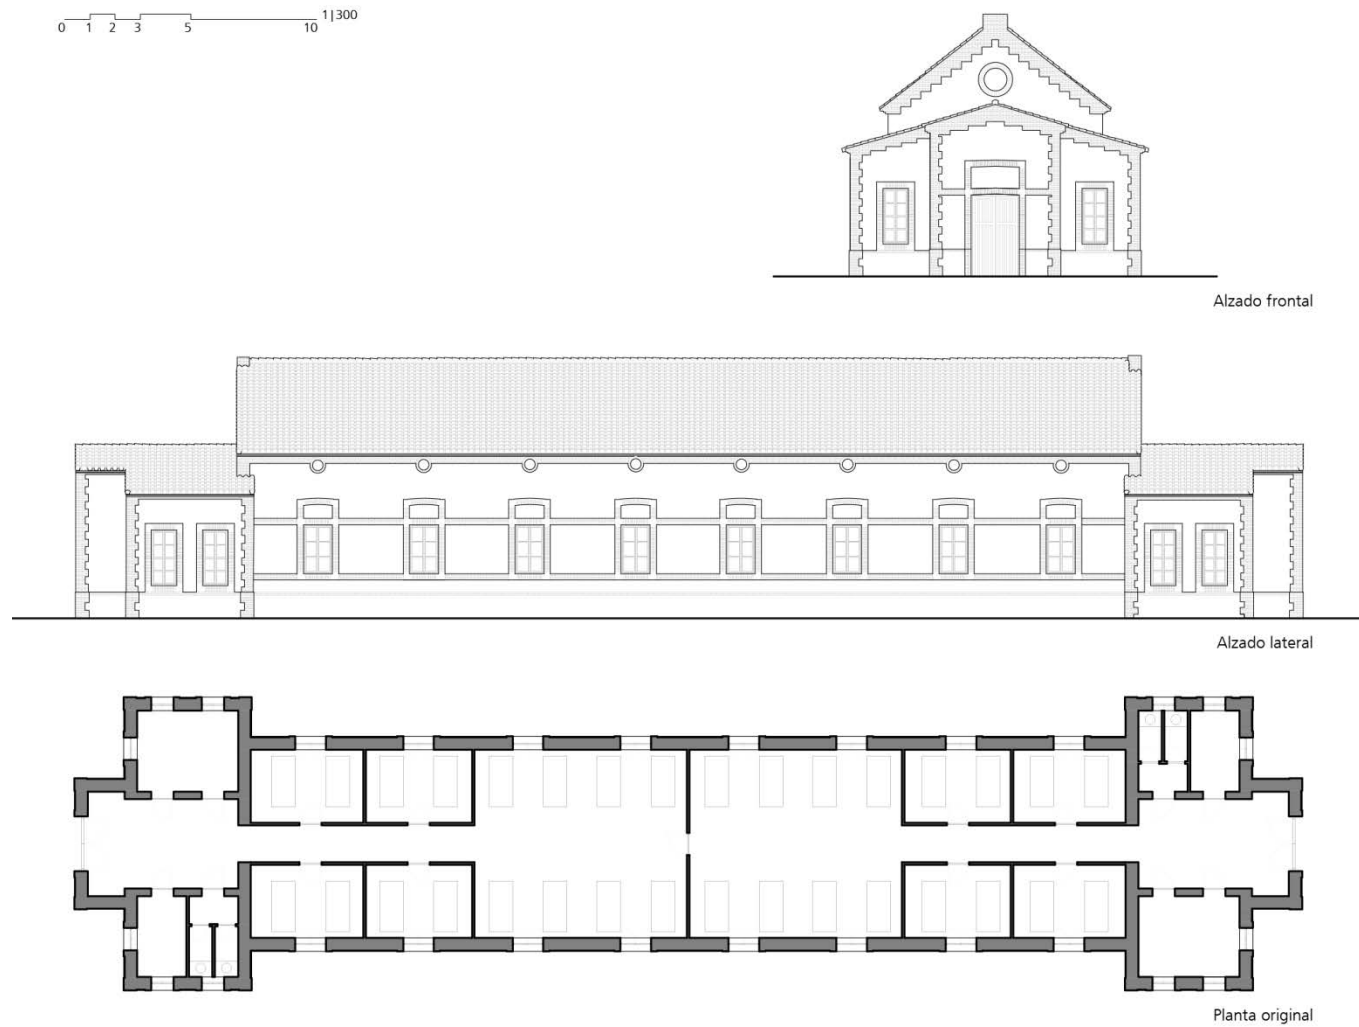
Levantamiento Planimétrico del Pabellón de La Purísima. Fase 1 (1904-1914).
